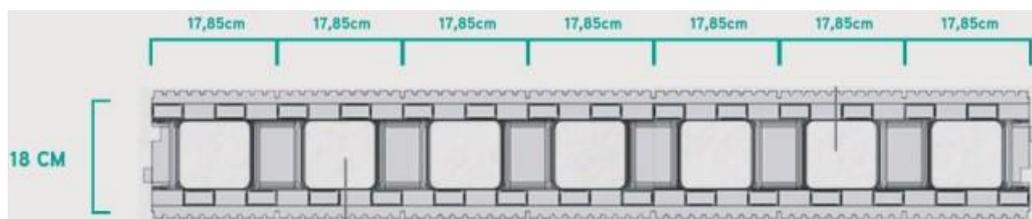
Vistas superior das formas (Fonte: ICF Construtora, 2023).
